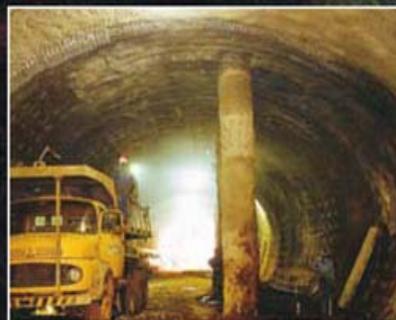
Passagem do Túnel de Via do Metrô DF sob estrutura com fundação profunda (CBT, 2006)
